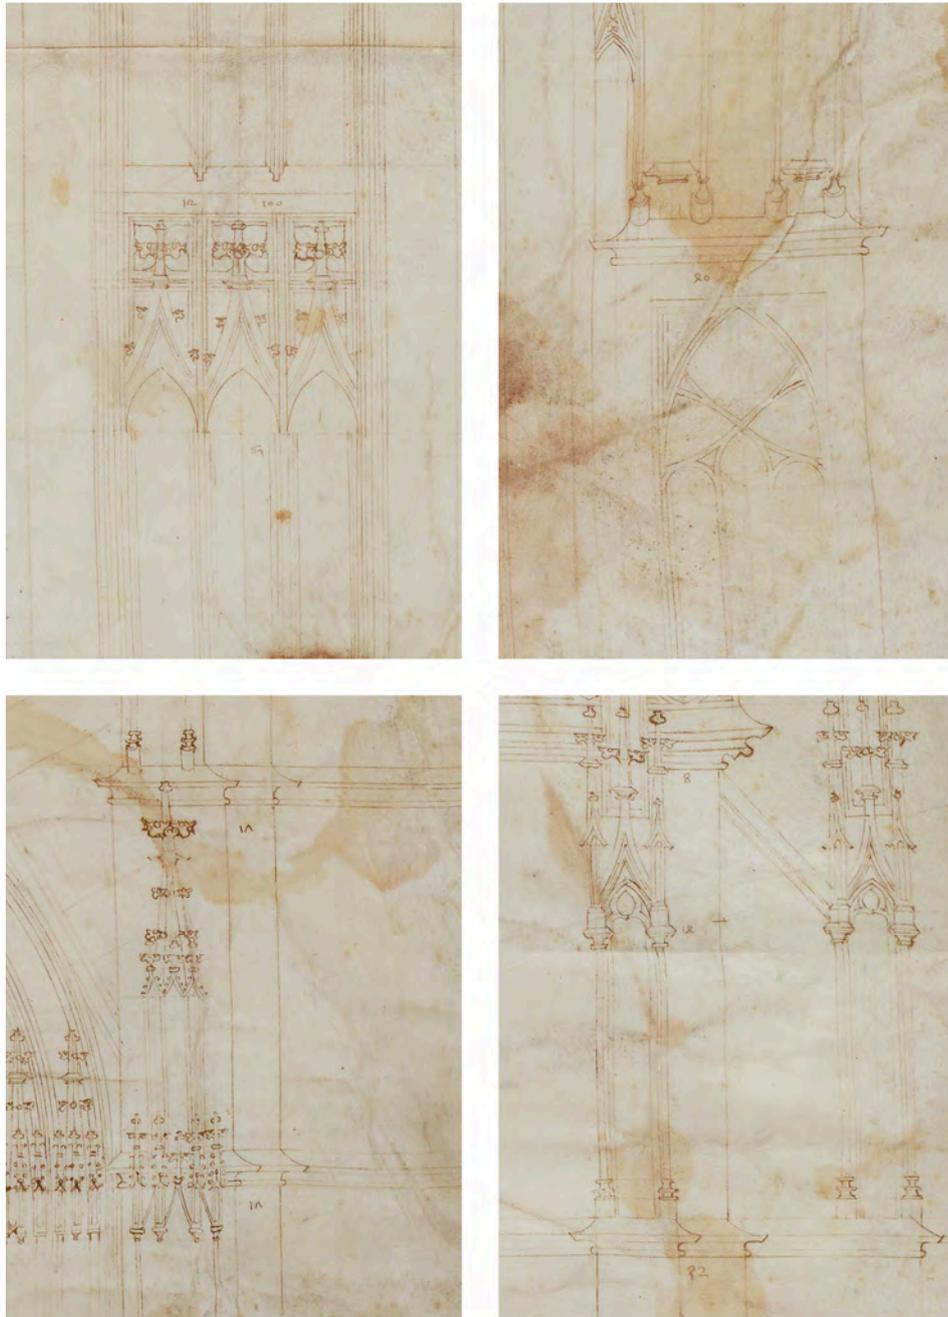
Detailausschnitte des Risses mit den eingetragenen Fußmaßen
